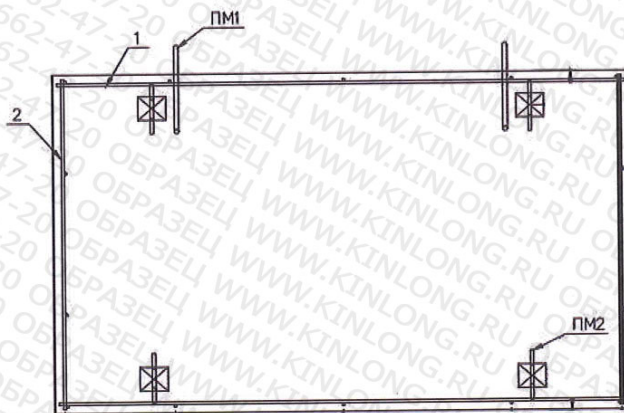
Схема армирования бетонного основания, где 1 и 2 – арматурный стержень класса А500 диаметром 10 мм
